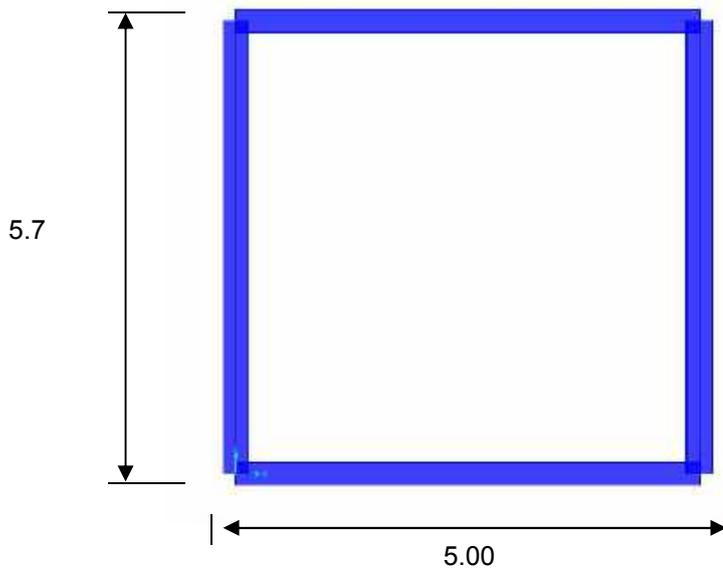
Vista de pórtico principal de túnel con cimbras metálicas
